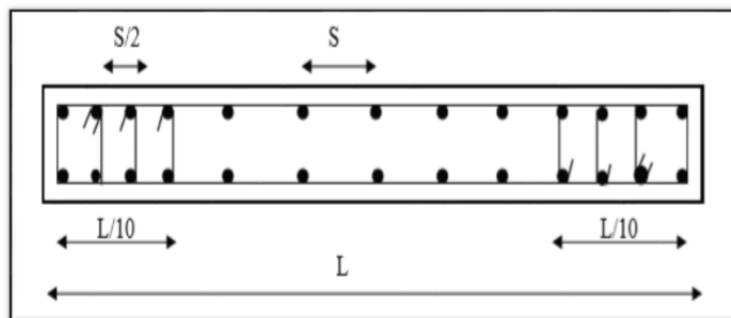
Disposition des armatures verticales (vue en plan)
